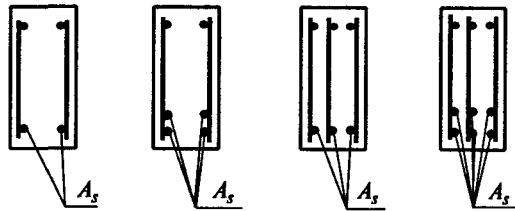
Варианты армирования балки — к примеру 7.4
